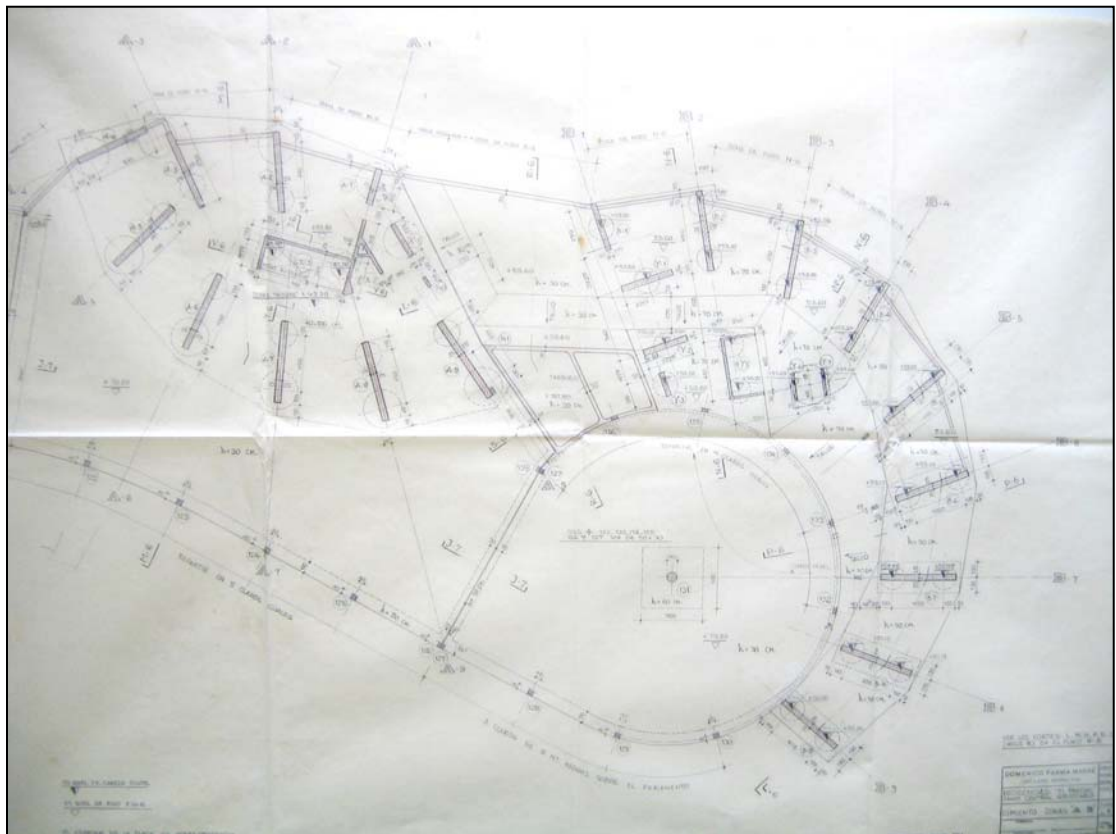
, 30 Planos cimentación, Torres del Parque. Fuente Archivo Parma Universidad de los Andes
